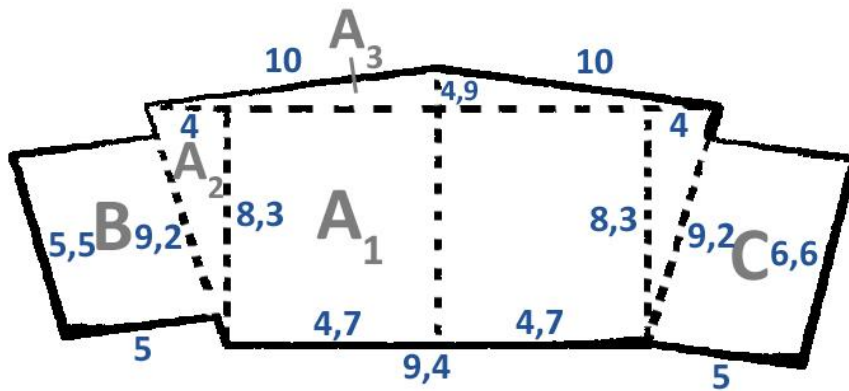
Grundriss der Kirche mit horizontalen Streckenmaßen in Meter. Abbildung nicht maßstabsgetreu!
